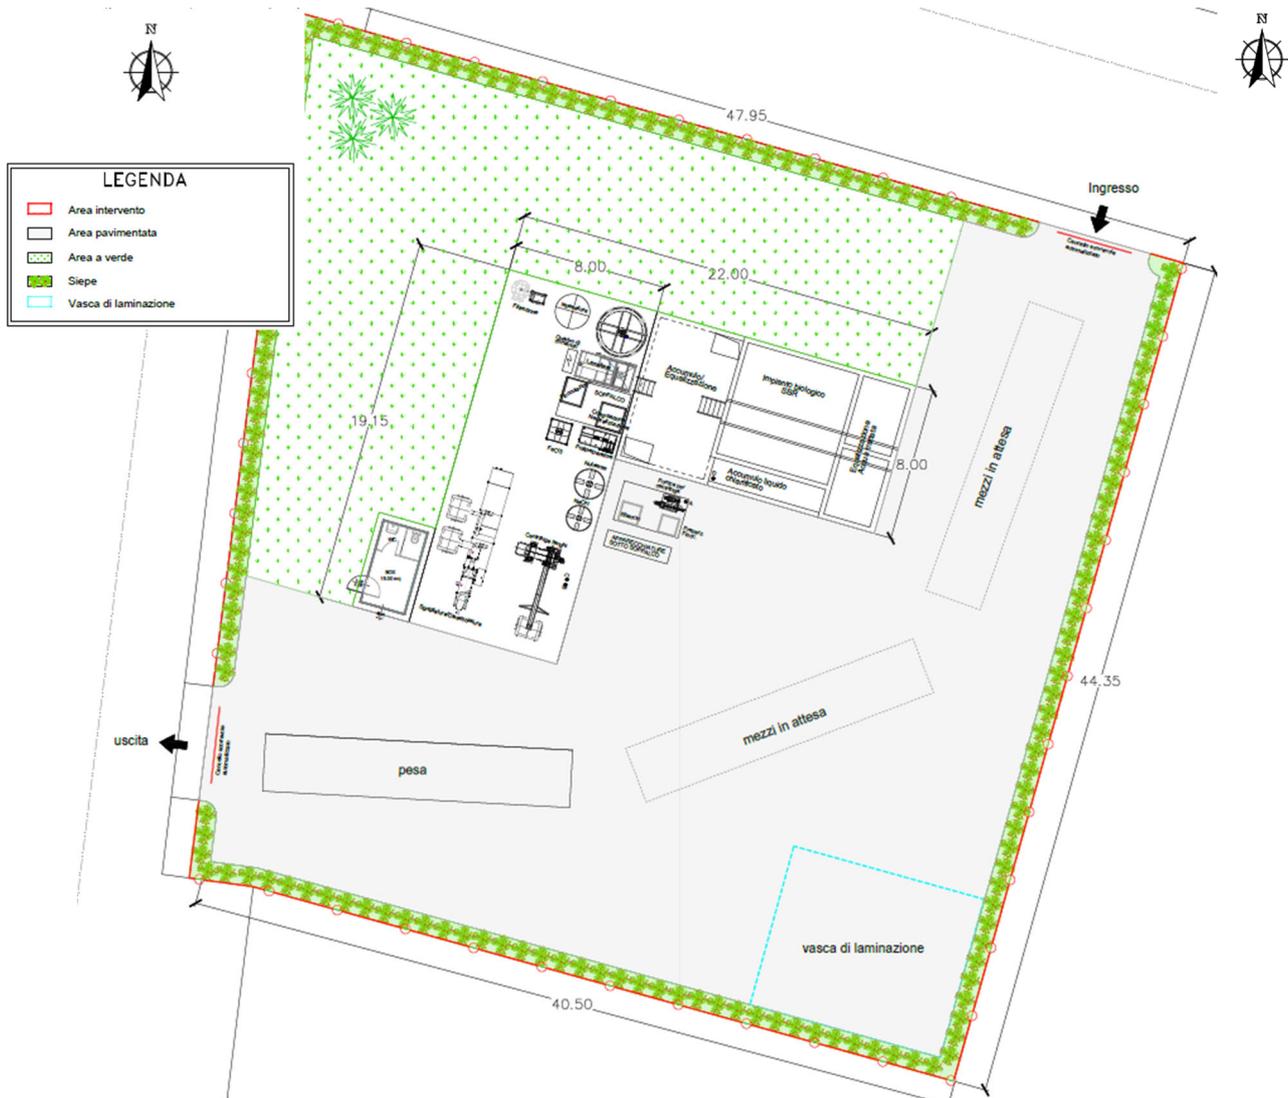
Organizzazione impianto nella planimetria di progetto (stralcio Tav. 4)
